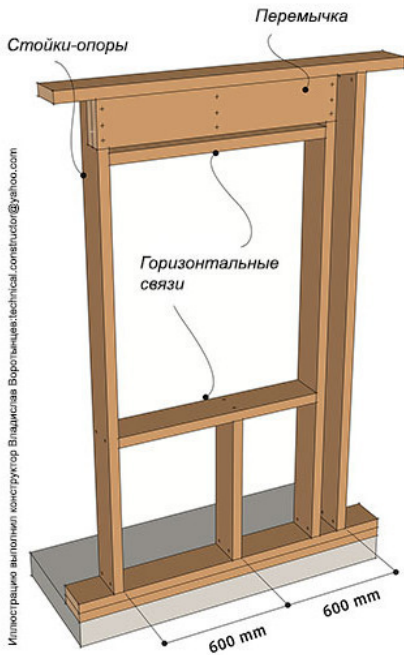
Проём в несущей деревянной каркасной стене с нагрузкой от кровли. Проём типа В
